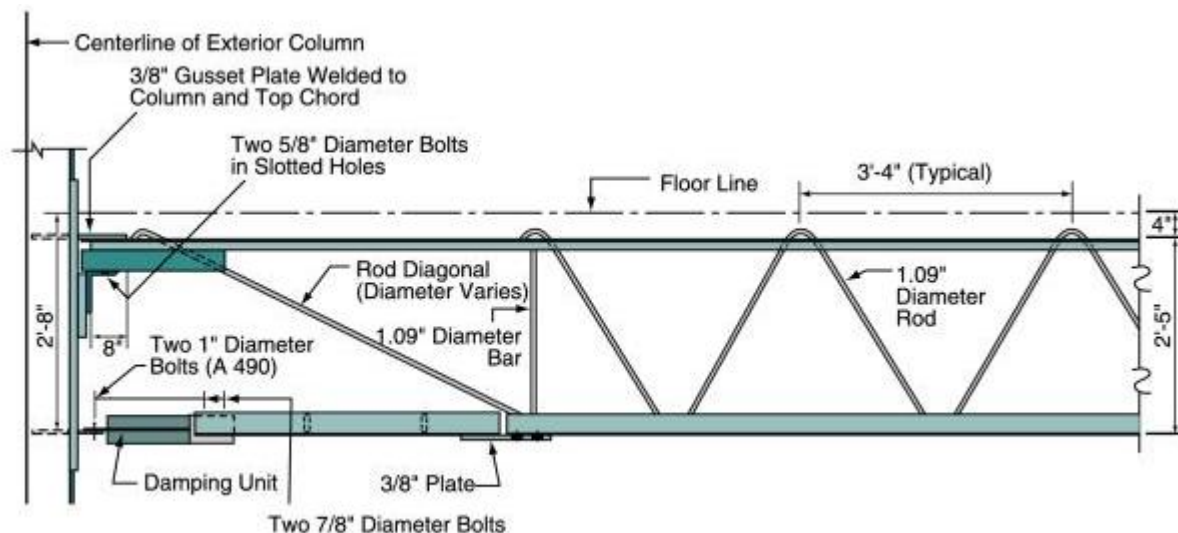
Detalhe da ligação entre o piso e o pilar da fachada [23].
